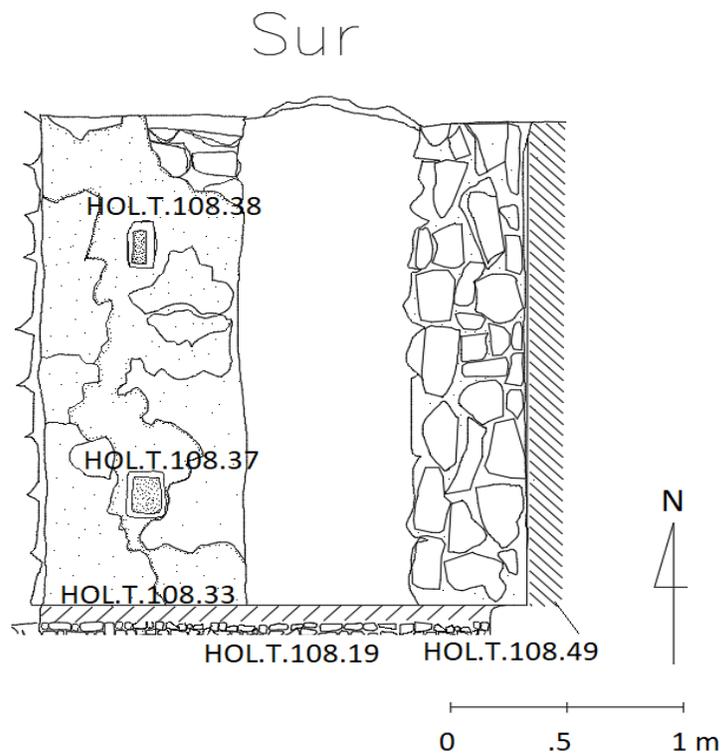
Perfil sur de la fachada norte del muro HOLT.108.33 con orificios HOLT.108.37 y HOLT.108.38 (Dibujo: Berenice García Vázquez).
